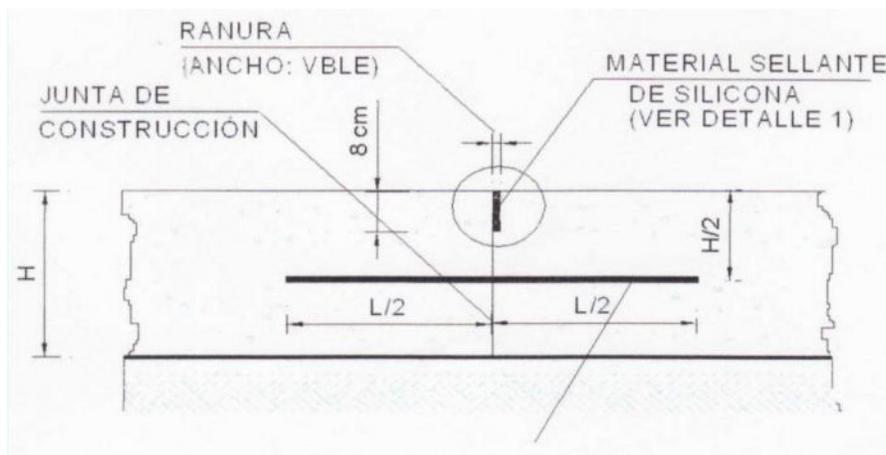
Grafico de detalles de pasa juntas y junta elaboración propia.
